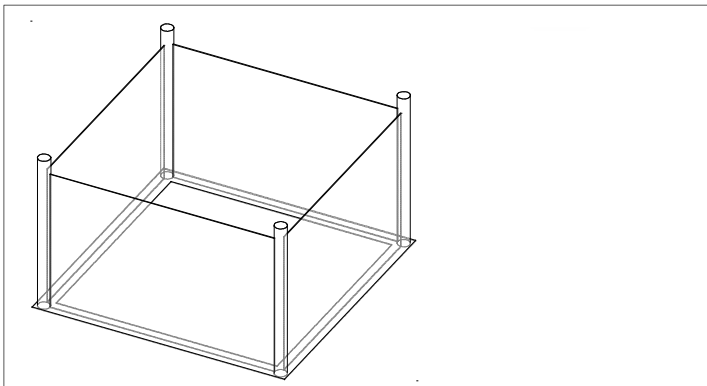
Estructura de apoyo para ensayo de mampostería.
